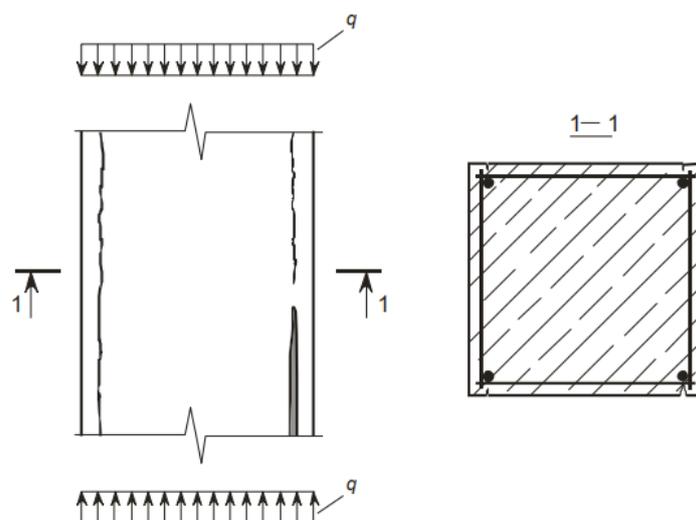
Трещины вдоль продольной арматуры
